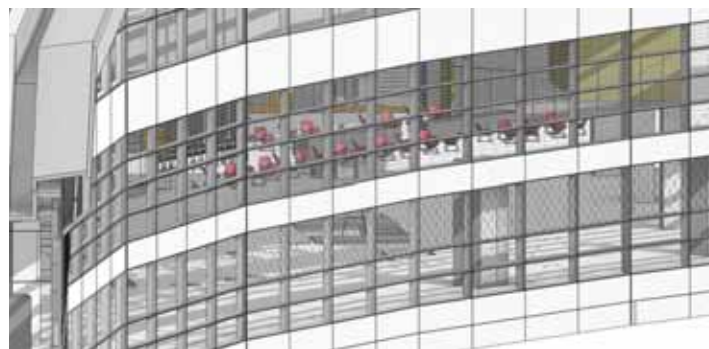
Stralcio modellazione 3D architettonica vista esterna facciate in ambiente BIM
